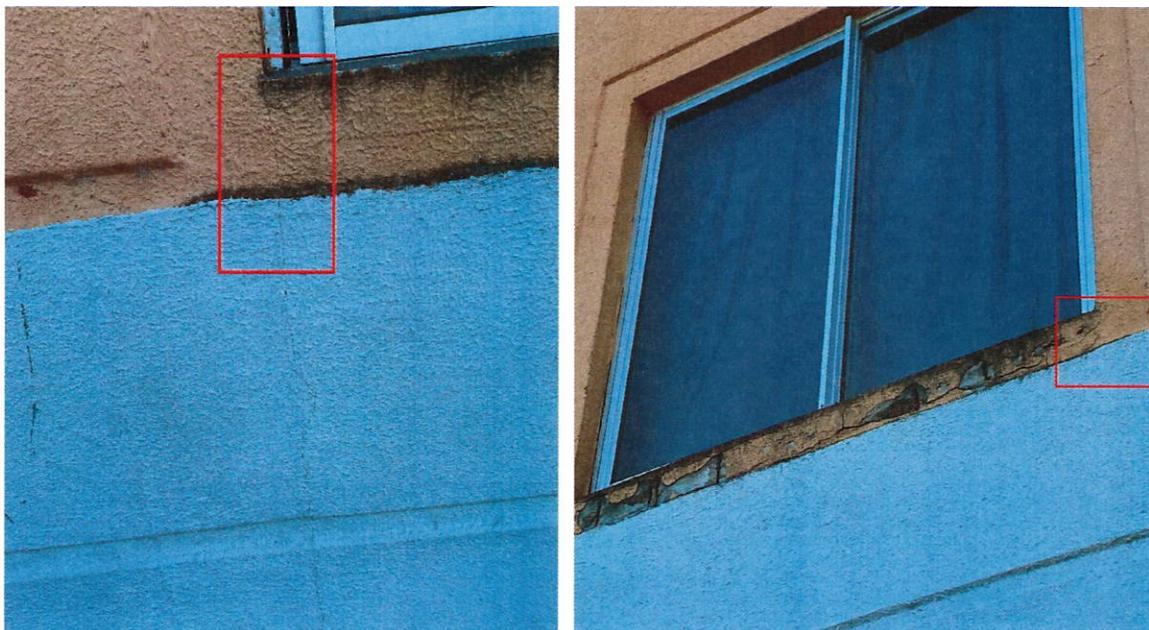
Fissuras em esquadrias devido à ausência ou extensão de contra verga
